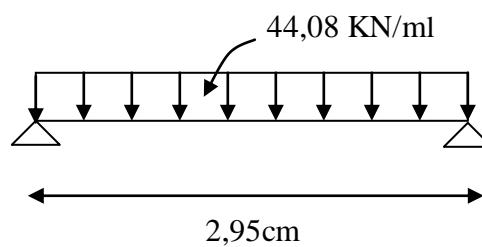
Schéma statique de la poutre à l'ELU.
